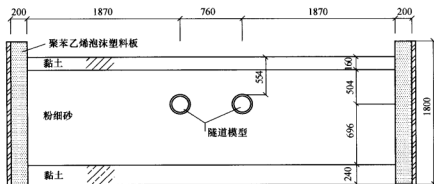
地铁区间隧道模型装箱示意图 (单位: mm)
